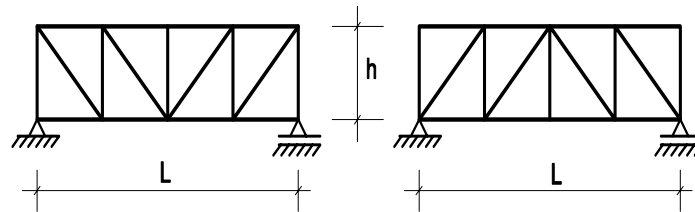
Vigas treliçadas com diferentes posições das diagonais.
